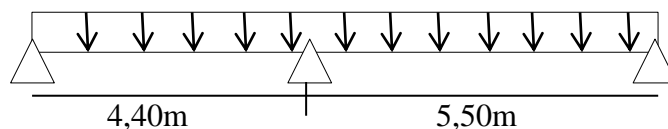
Schéma statique de poutrelle Type 2 (1^{er} étage)
